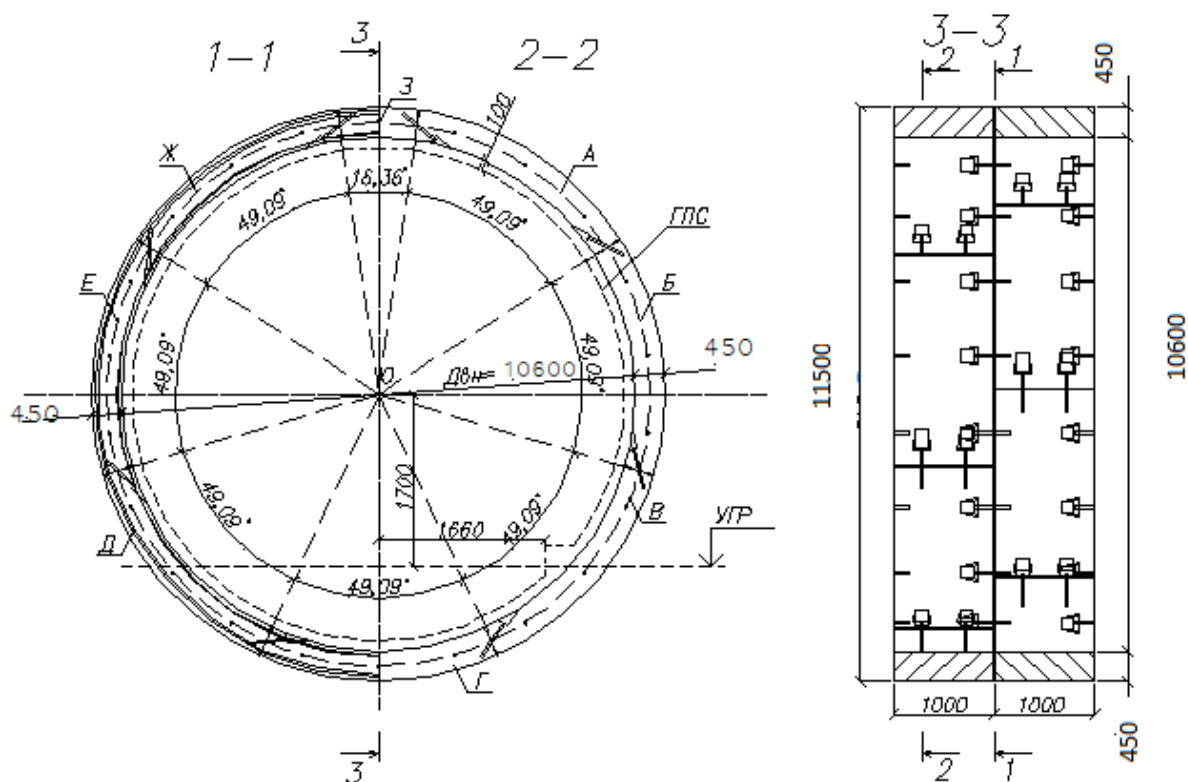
Железобетонная блочная обделка повышенной водонепроницаемости
